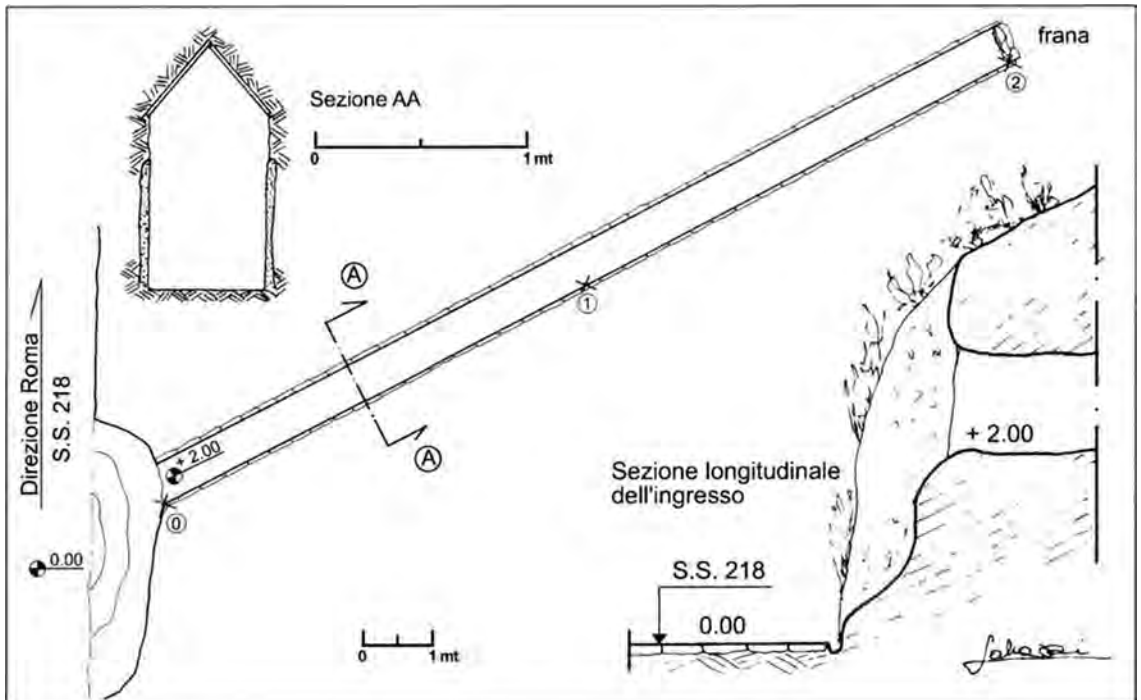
Pianta e sezioni della CA122 (grafica C. Germani, A. De Paolis)
